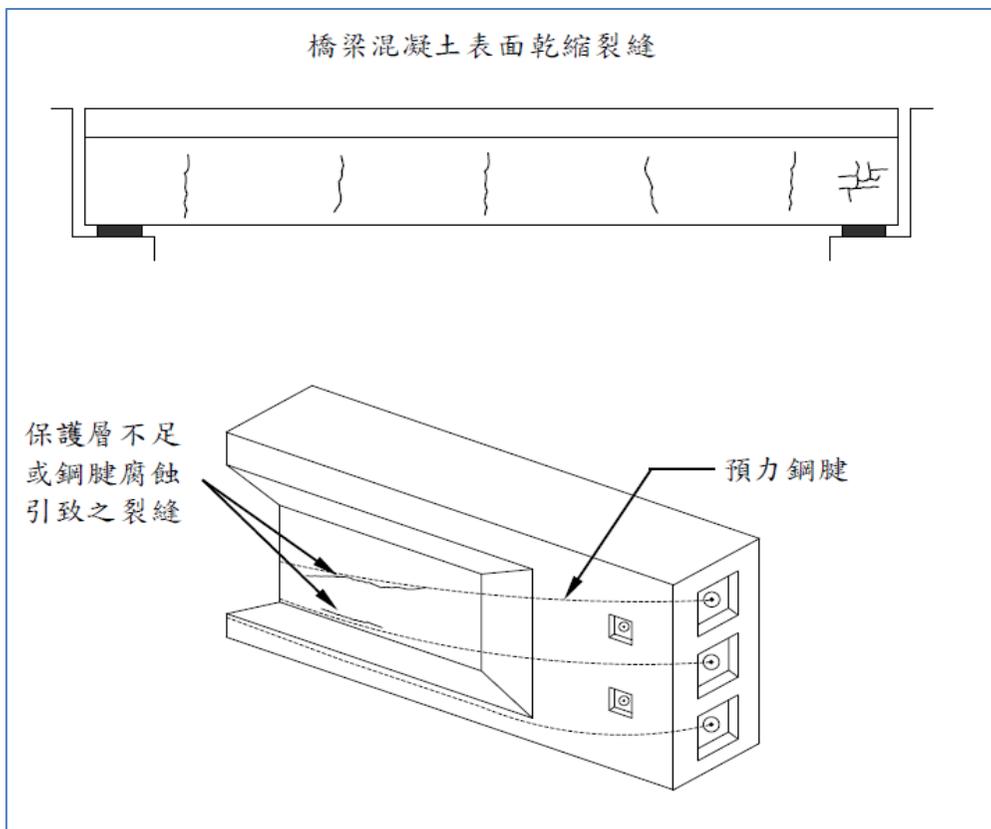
混凝土橋梁非結構裂縫示意圖
